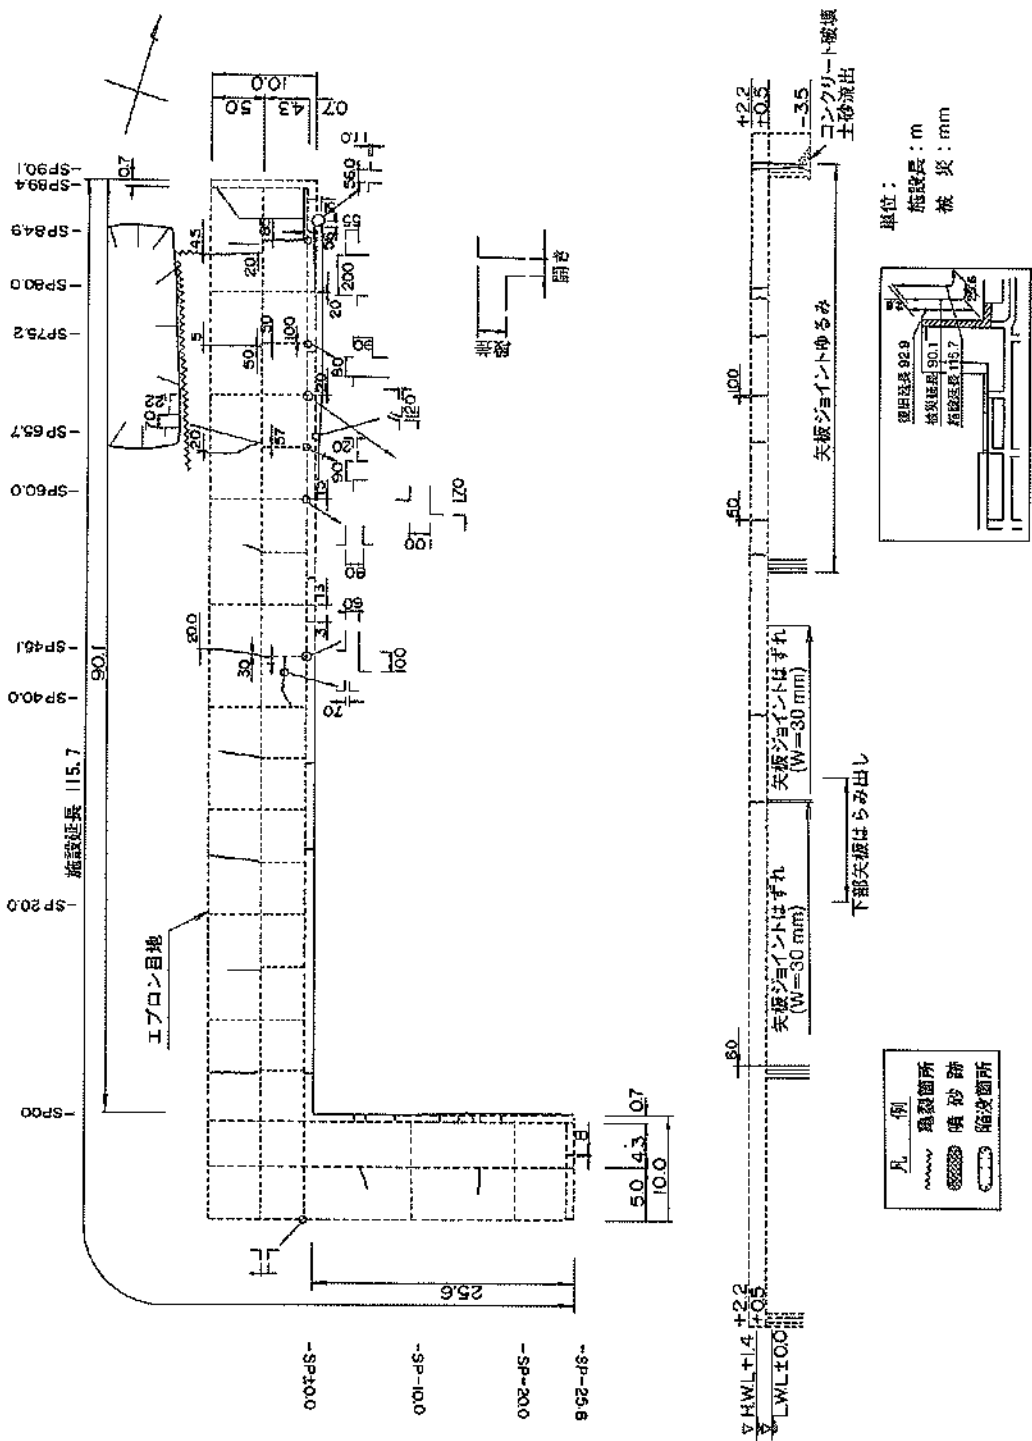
被災状況平面図 (中央埠頭物揚場-3.5m)
